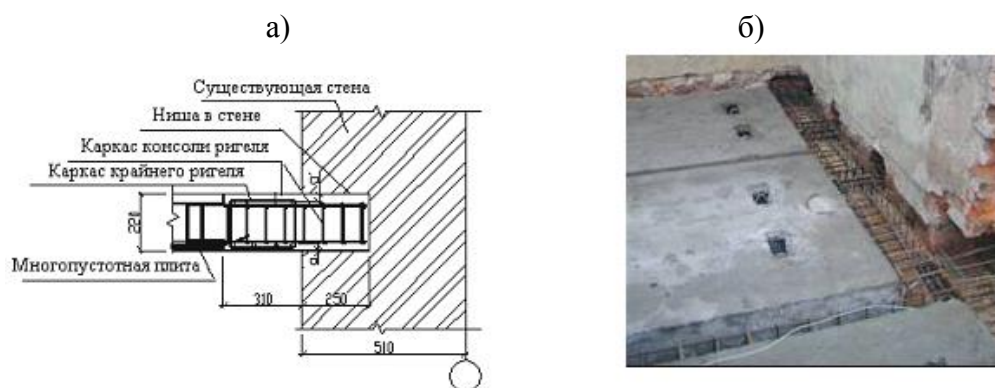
Узел сопряжения сборно-монолитного диска перекрытия с существующей наружной стеной (а) и общий вид примыкания (б)
